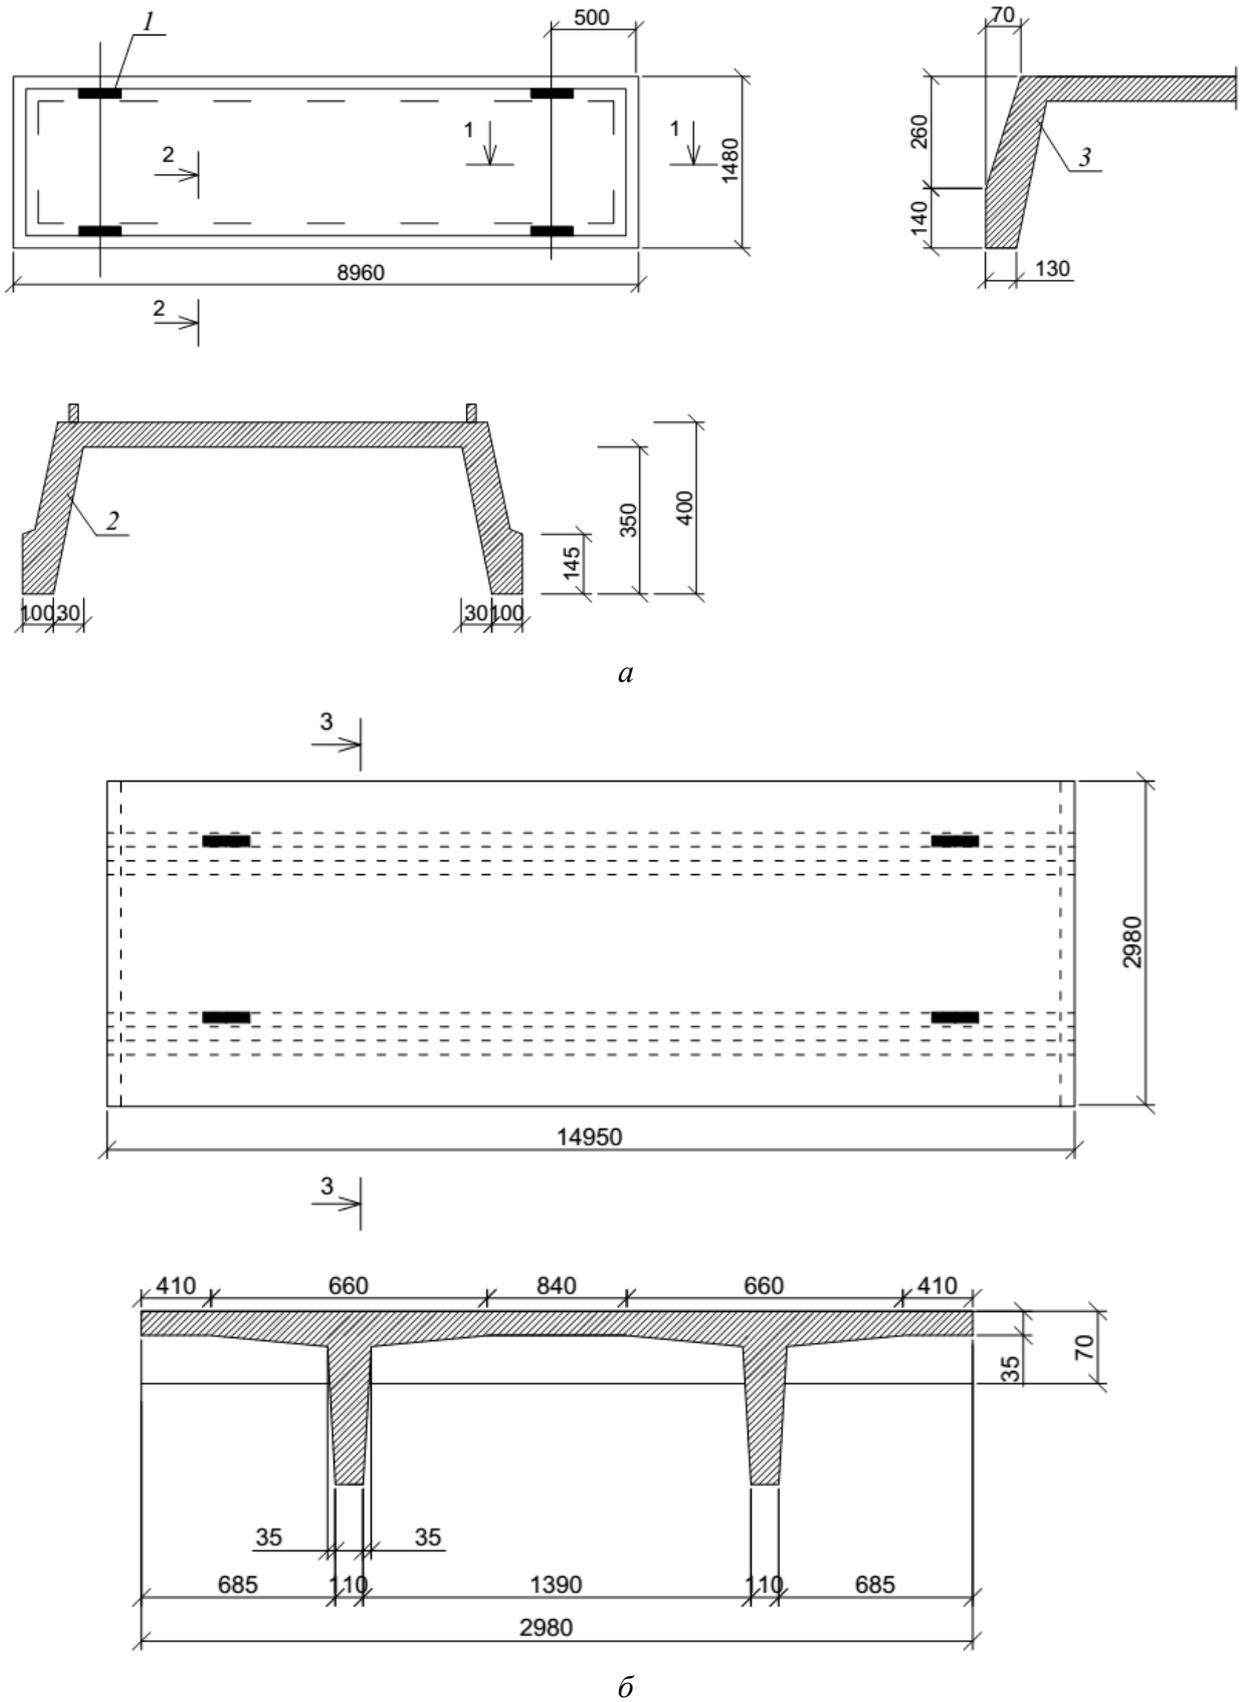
Предварительно напряженные настилы: *а* — ребристый предварительно напряженный настил пролетом 9 м; *б* — предварительно напряженный настил типа ТТ-12 (12 М) ТТ-15 (15 М): 1 — монтажные петли; 2 — продольные ребра; 3 — поперечные ребра
